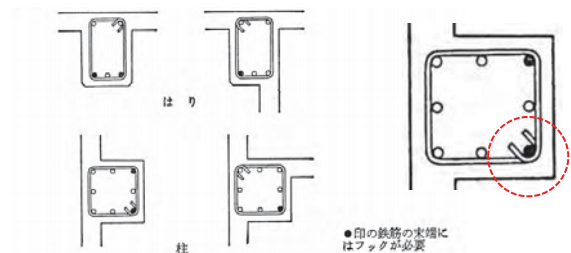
異形鉄筋でも建築基準法によって末端にフックを必要とする出すみ部の鉄筋
